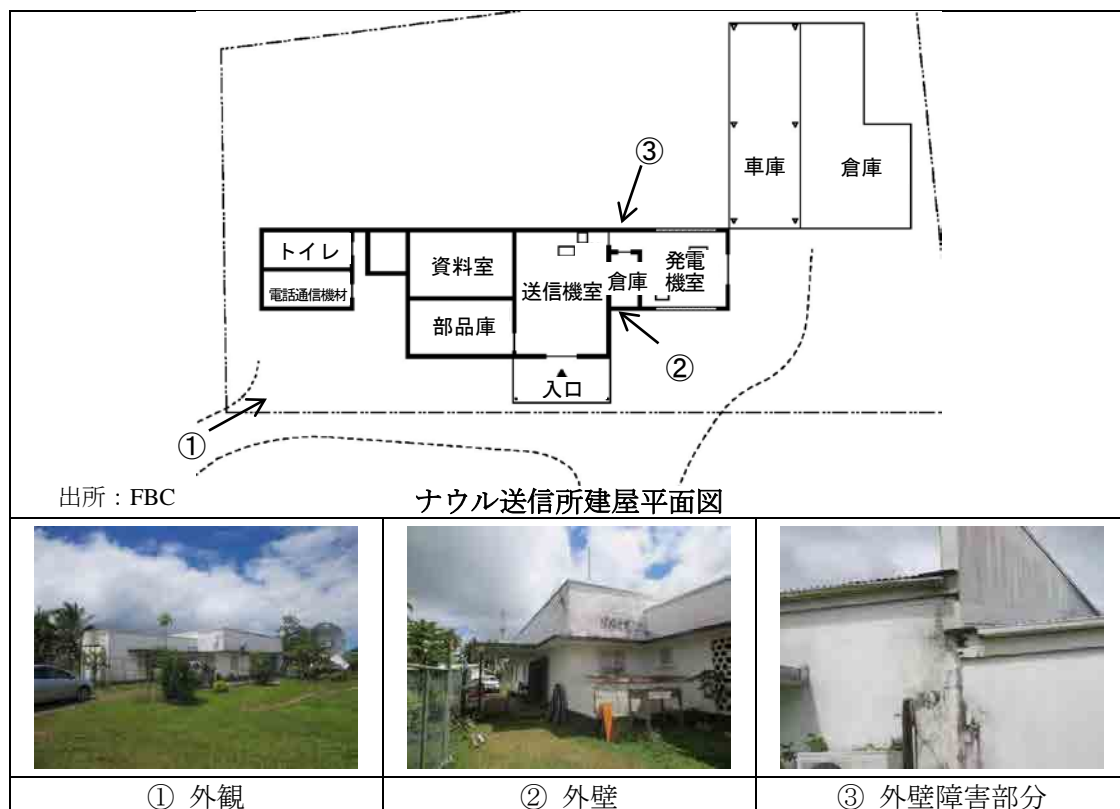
ナウル送信建屋の平面図及び外観写真
